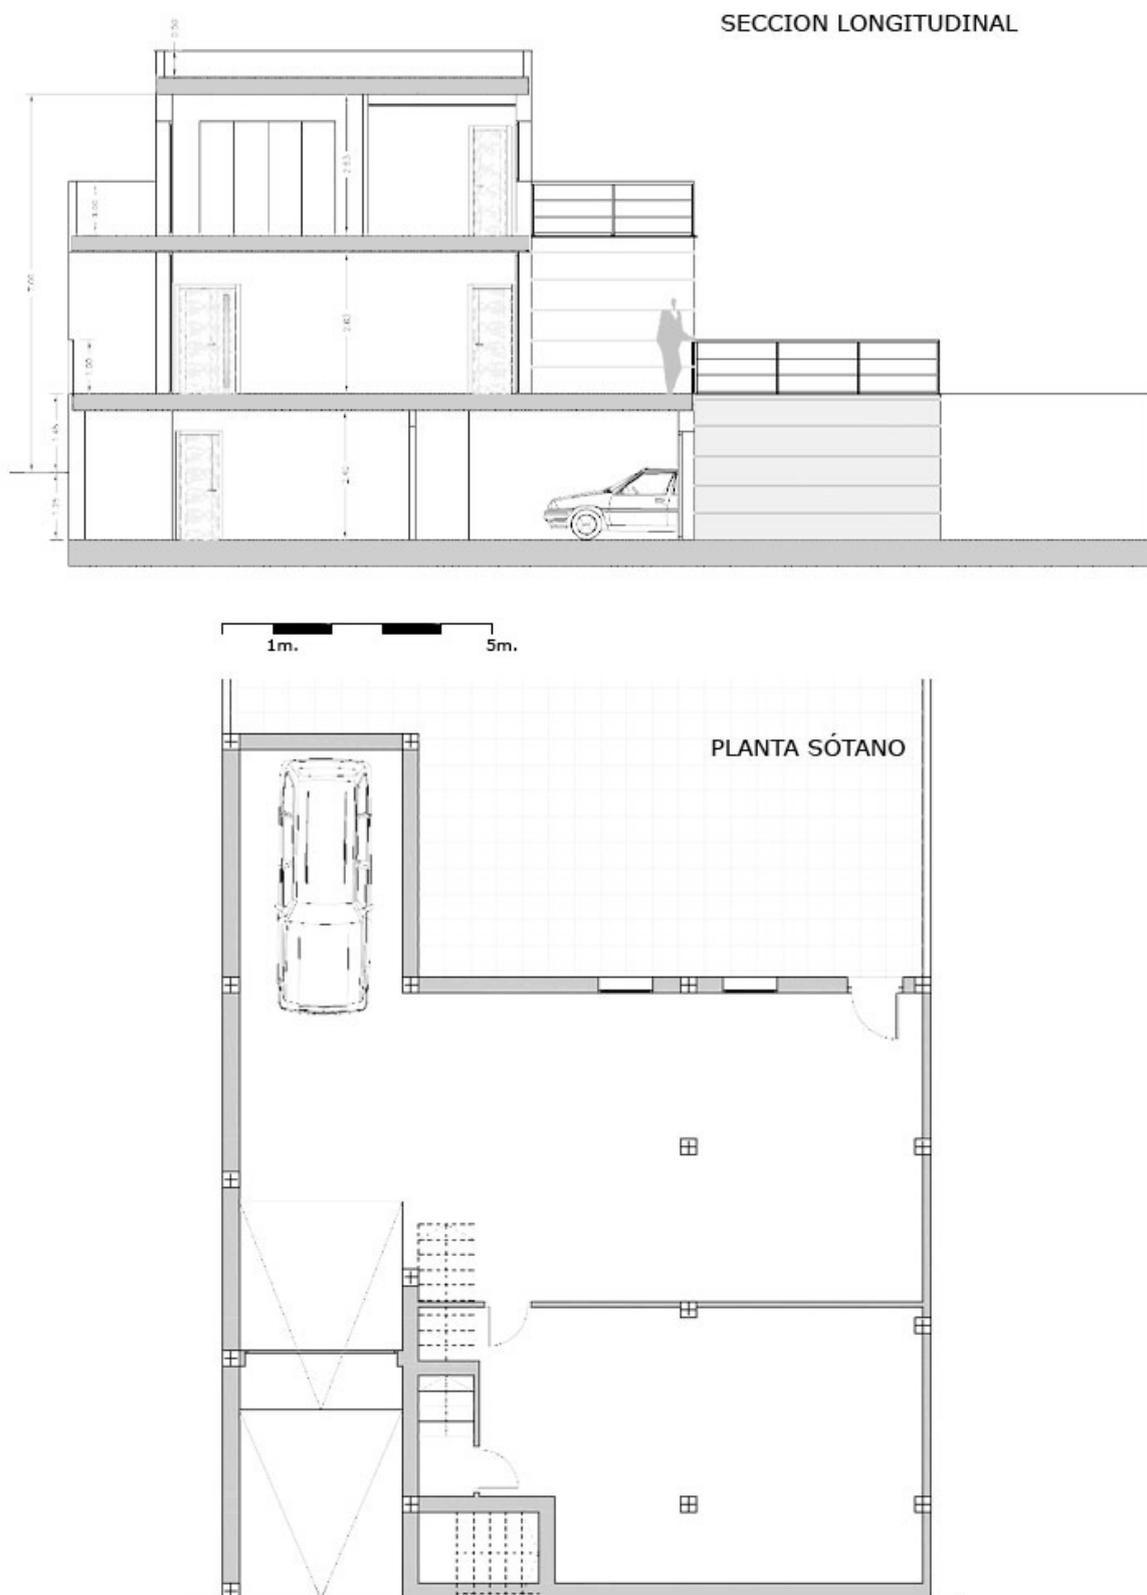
Planta Sótano y Sección Longitudinal de la Vivienda Nueva en C/ D. Díaz de Villar 53 (Castuera)
